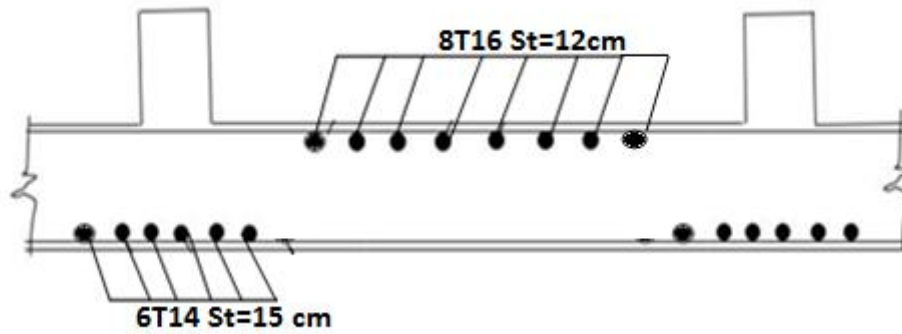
Schéma de ferrailage de la dalle du radier (sens xx)
